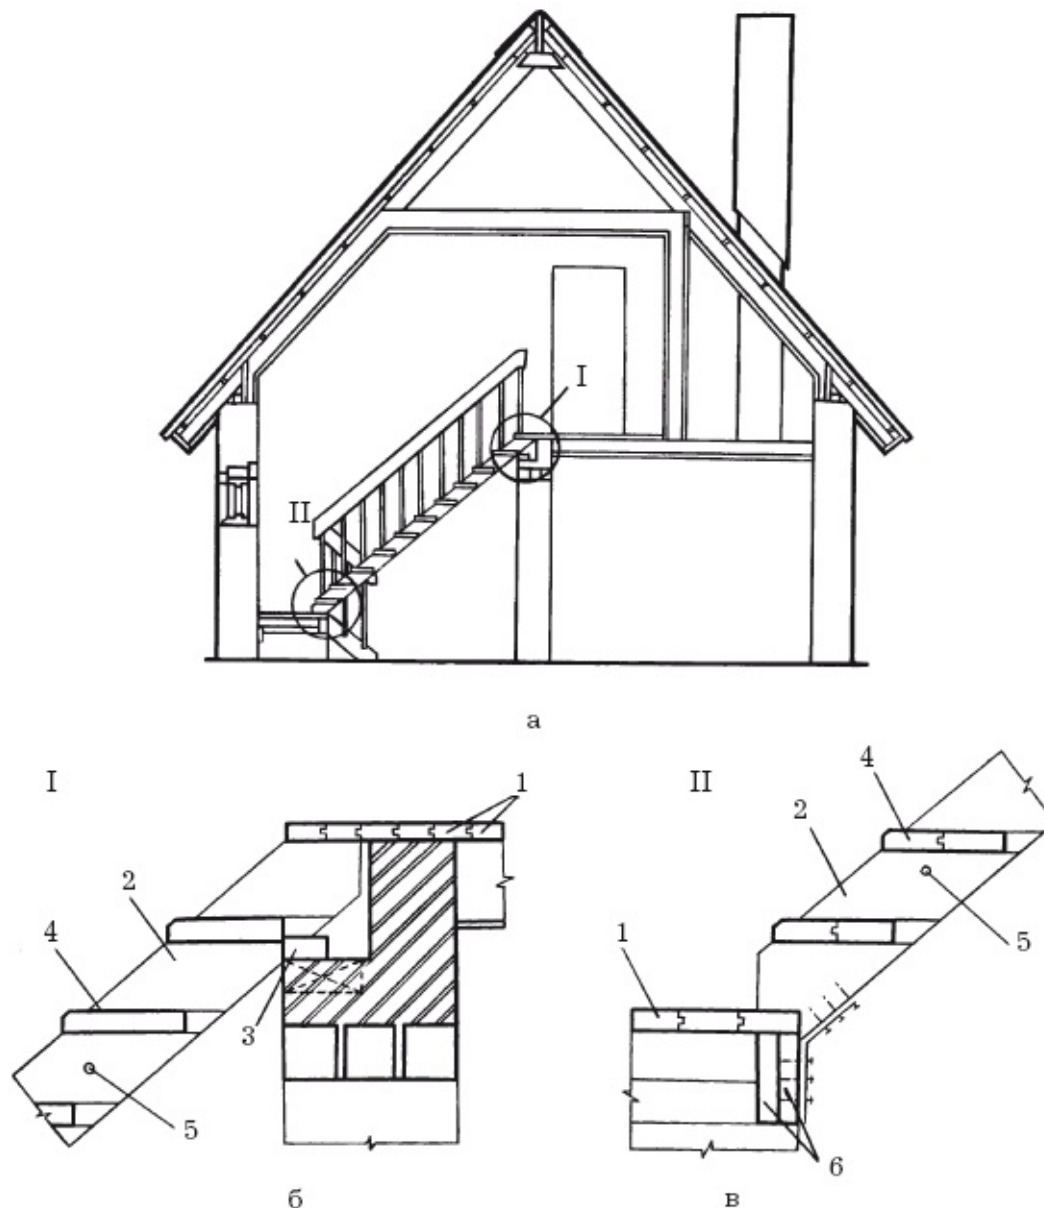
Общий вид и конструктивные элементы двухмаршевой внутренней лестницы: а – общий вид; б, в – конструктивные элементы: 1 – доски пола; 2 – тетива; 3 – опорный брус; 4 – проступь; 5 – стяжной болт; 6 – балка площадки
